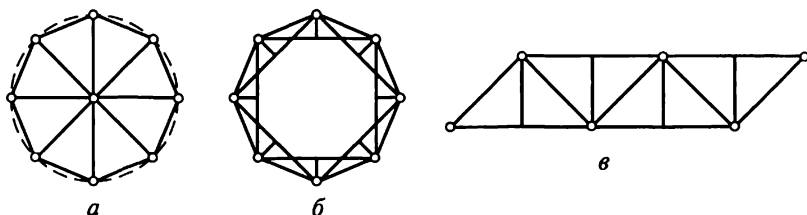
Схемы опорных сетей для высокоточной установки оборудования: *а* — радиально-кольцевая; *б* — кольцевая; *в* — линейного типа
